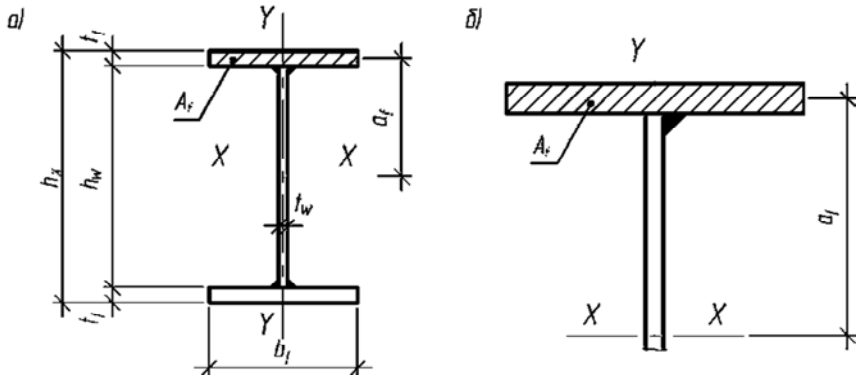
Узлы соединения полки со стенкой балки составного сечения:
